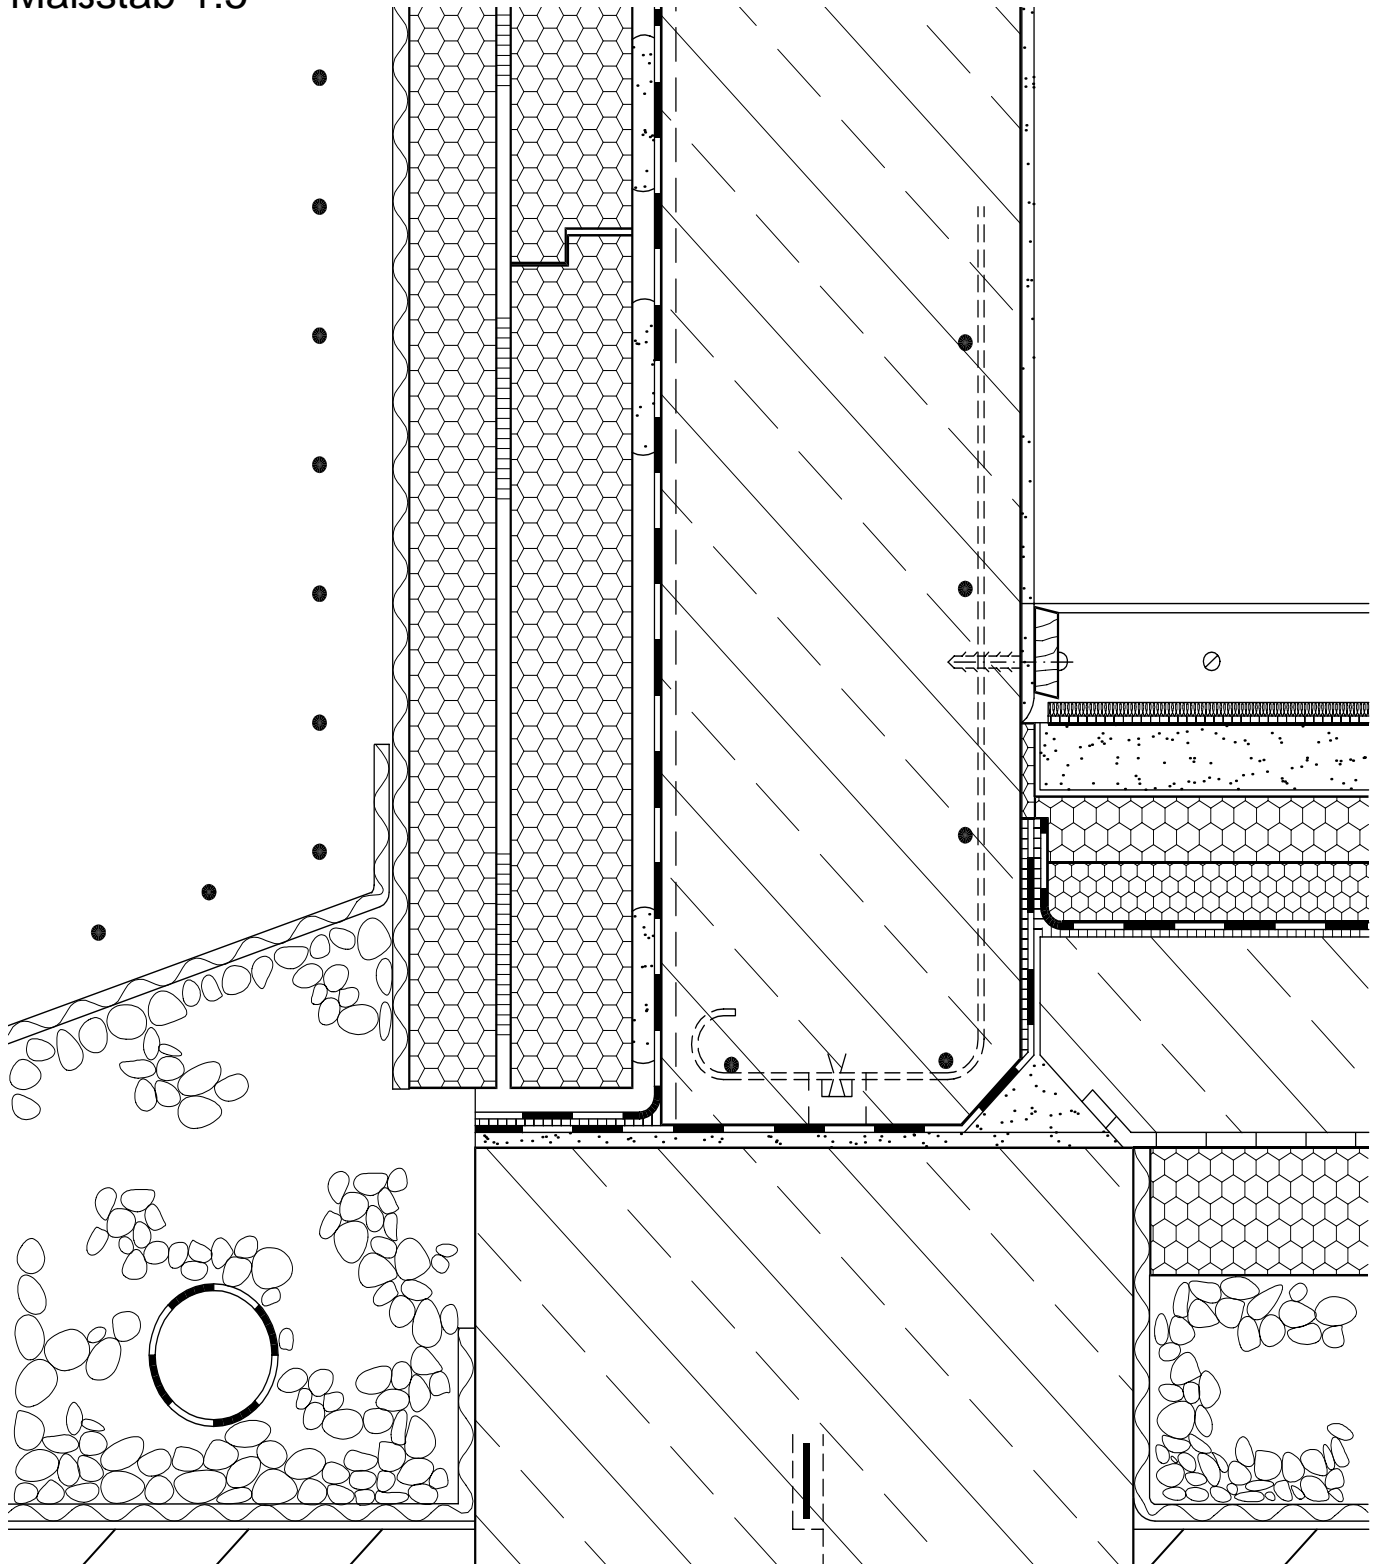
Fundamentausbildung bei Stahlbeton-Kellerwand und Dränung
